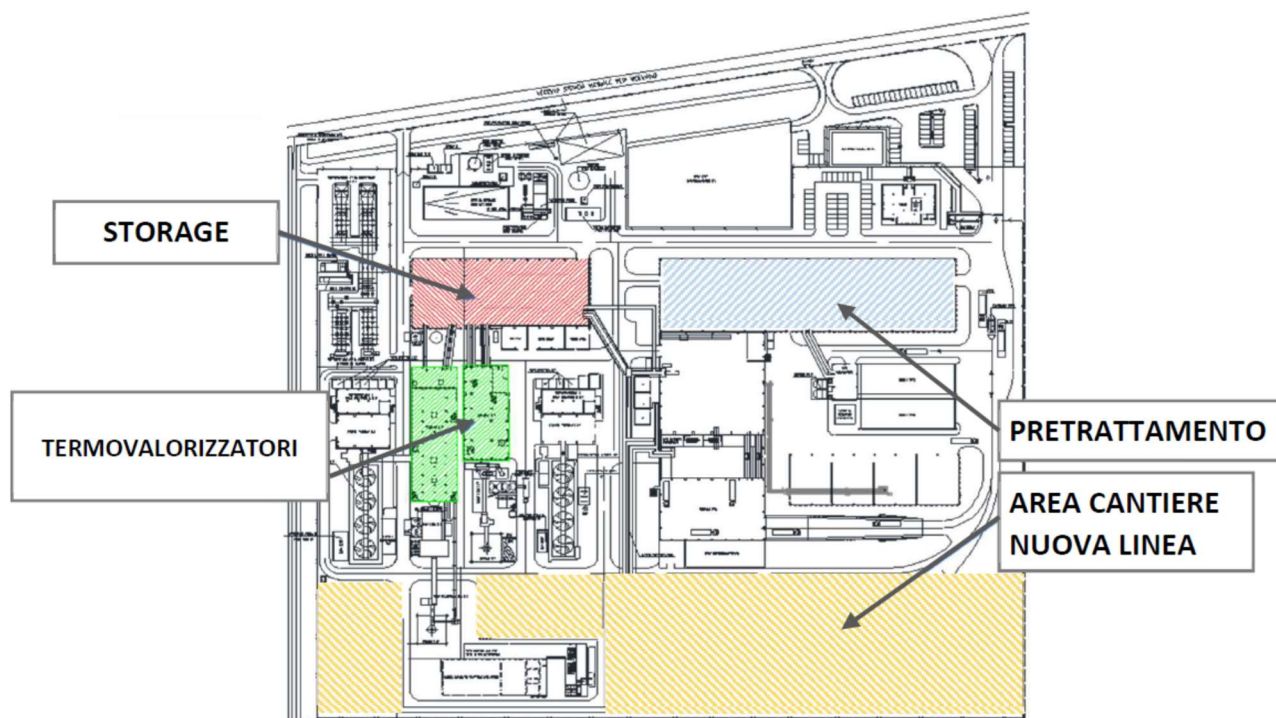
PLANIMETRIA GENERALE DELLO STABILIMENTO
